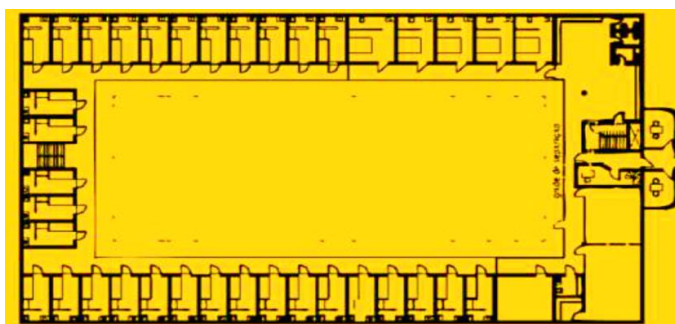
Planta do módulo de vivência do Centro de Reeducação de Governador Valadares
